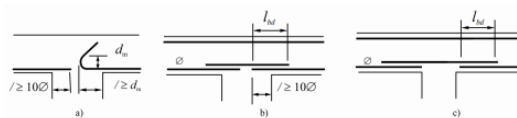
Anclaje de armadura inferior en apoyos intermedios
